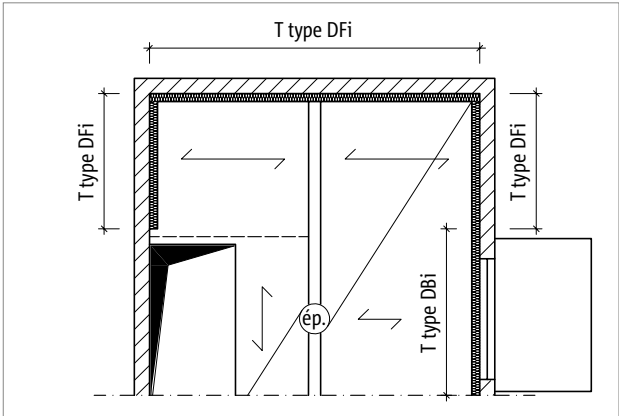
Schöck Rutherma® T type DBi : vue en plan
